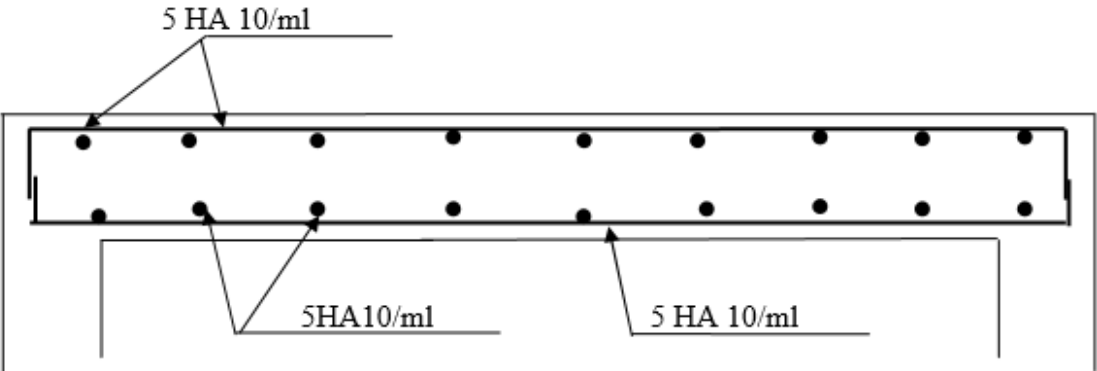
Plan de ferrailage de la salle machine suivant x-x.
